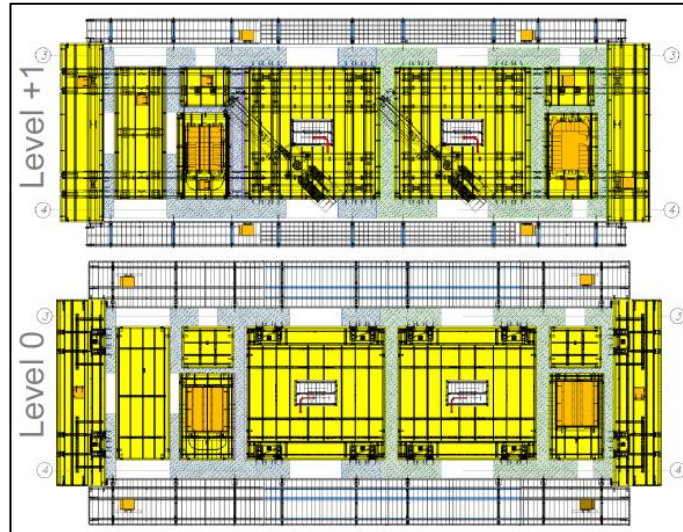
18 Vista en planta de plataforma SCP nivel 0 y nivel +1 (DOKA, 2016)
